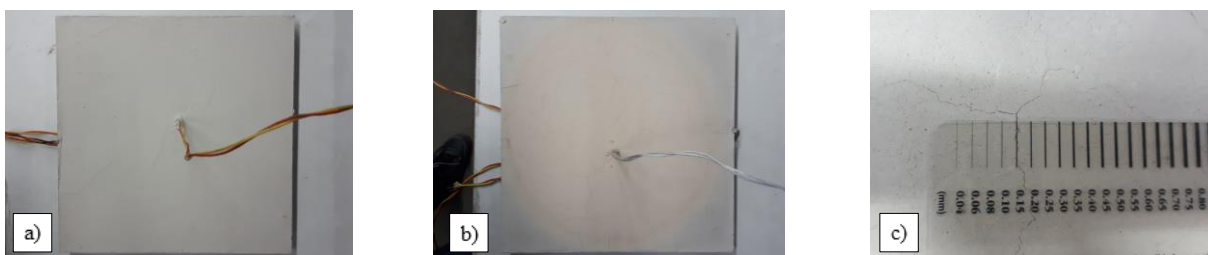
Provete P_A3_2_MI: a) Provete antes do ensaio; b) Provete após o ensaio; c) Fissuração do provete após o ensaio.
